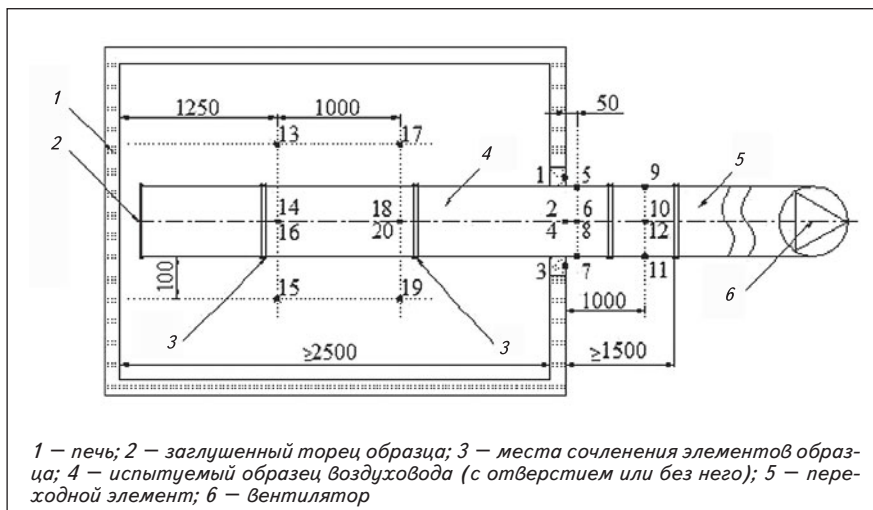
Схема конструкции узла пересечения конструкций огнестойкими воздуховодами
